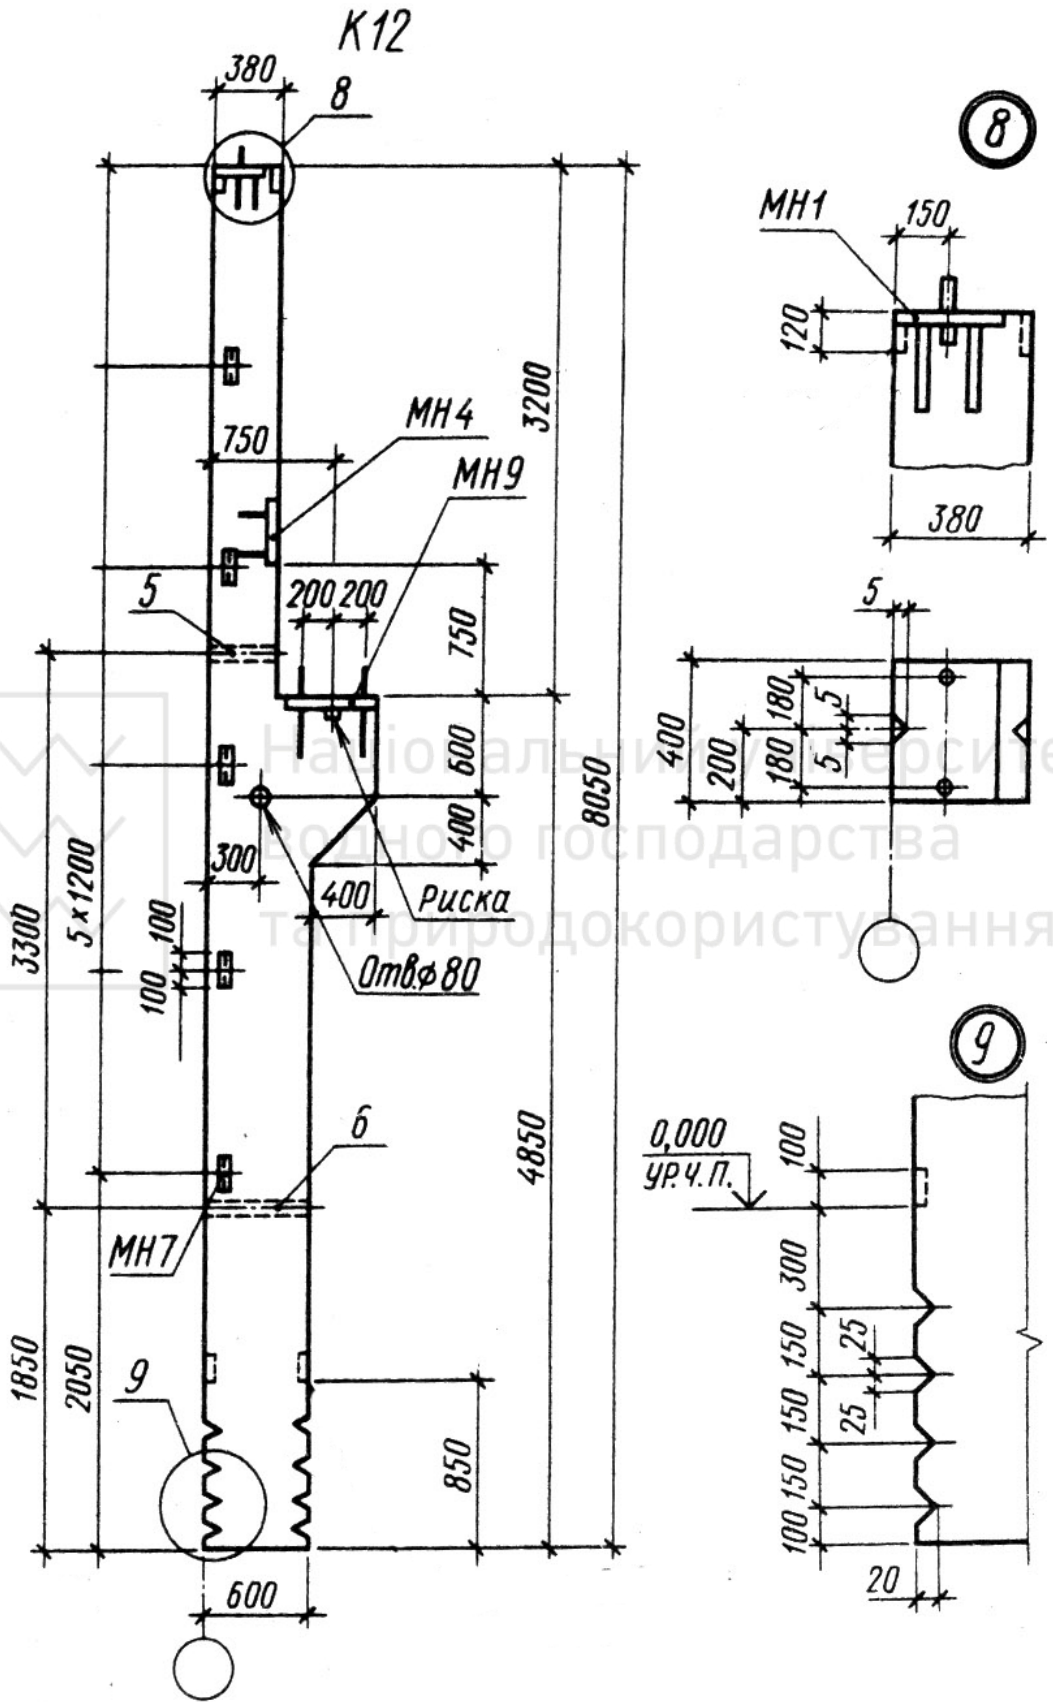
Складальне креслення залізобетонної колони К 12 та виносні елементи 8 і 9
